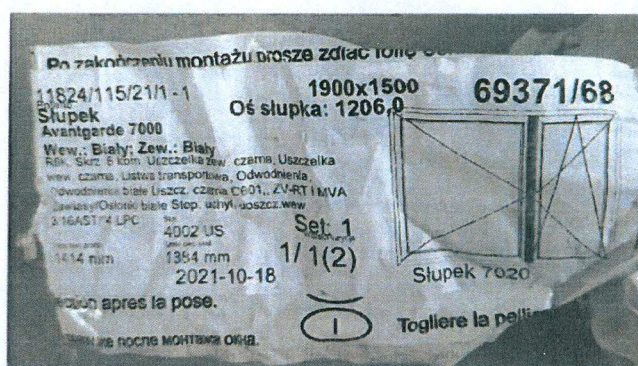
Widok próbki przyjętej do badań wraz z etykietami i oznaczeniami (zdjęcia wykonane przez Laboratorium LZE)
